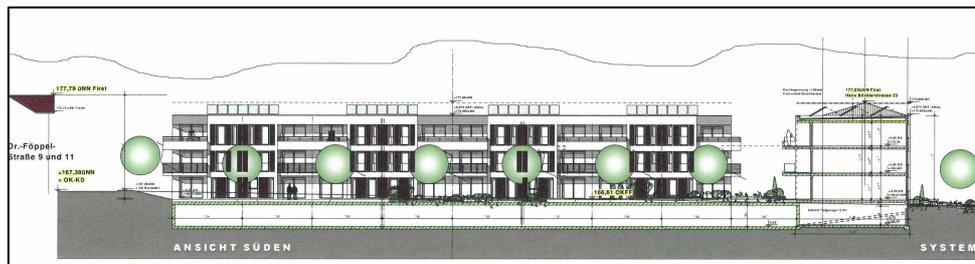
Projektplanung „Ansicht Süden mit Systemschnitt“
